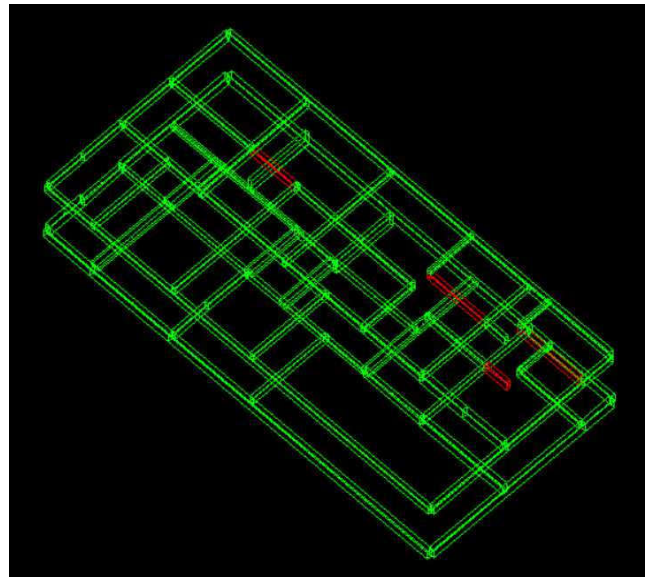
SLV 65% - verifiche travi II° e III° solaio
